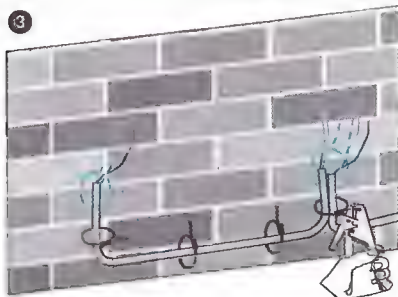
Принцип прокладки электропроводки за термоизоляционными стеновыми панелями
